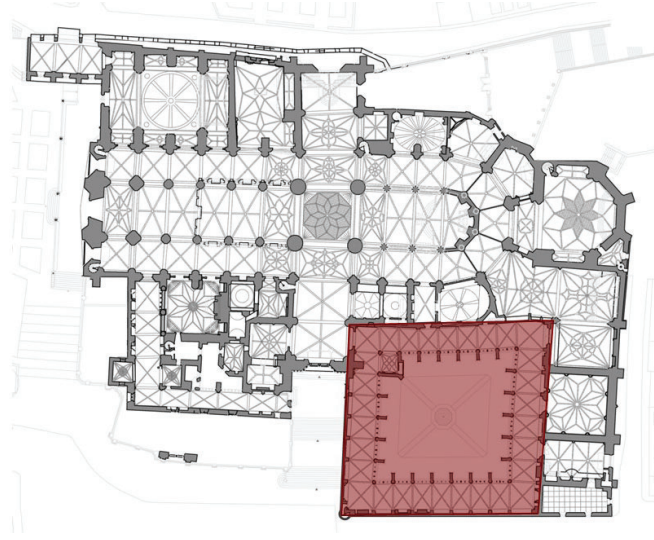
Planta general de la Catedral. Ubicación del claustro. Image 4. General floor of the Cathedral. Cloister location
